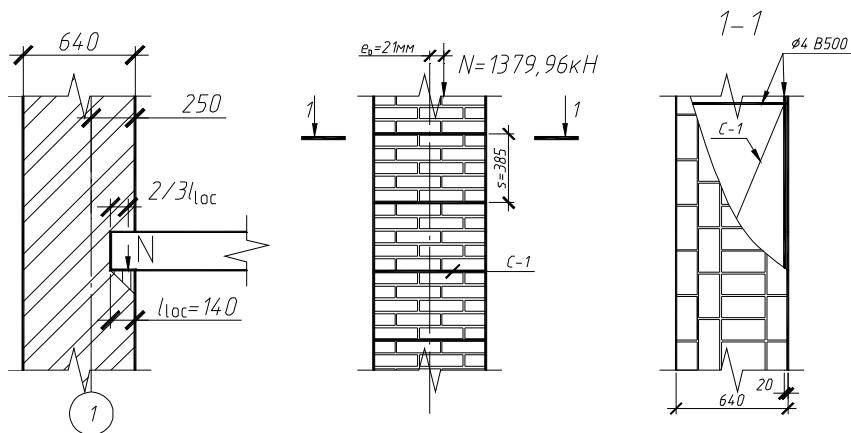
К расчету кирпичного простенка с сетчатым армированием
